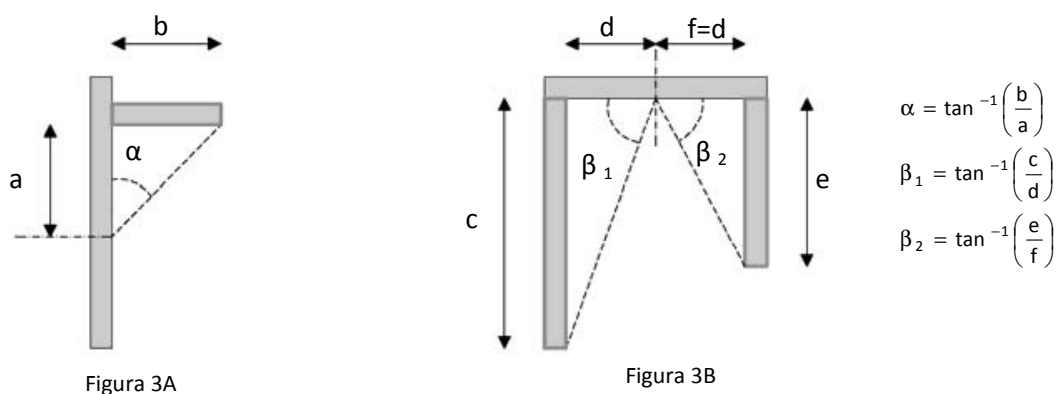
Pareti opache con aggetti orizzontali e verticali (A: sezione verticale; B: sezione orizzontale)
